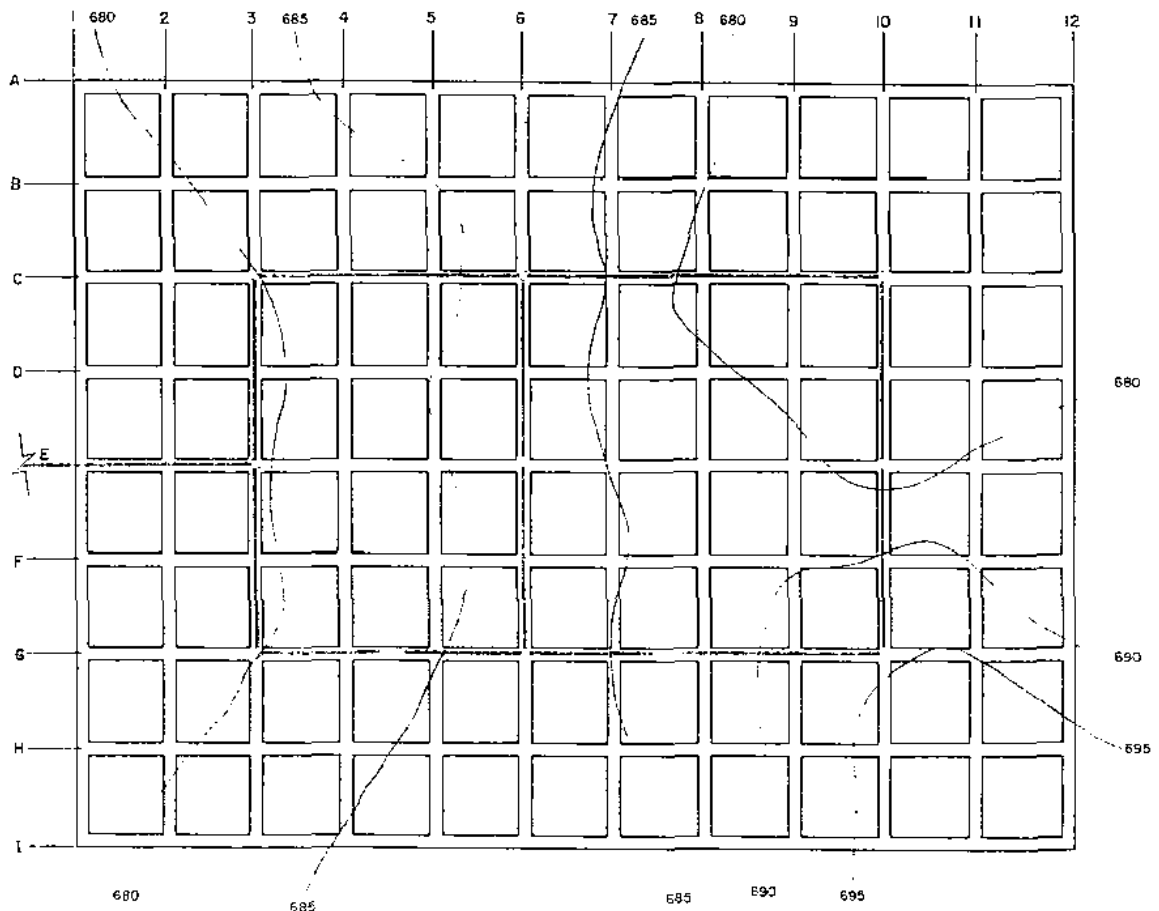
Plano de Planta y Esquema de mallado interno para una red dada.
